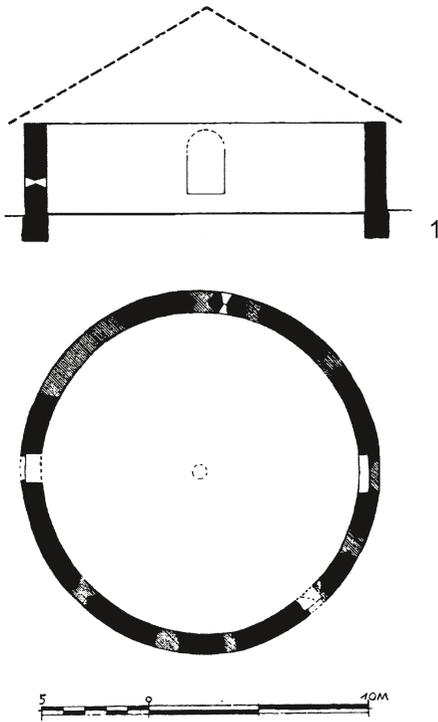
Hausbach, Stadt Vilshofen. 1 rekonstruierter Aufriss (nach Haas 1966, 141 Abb. 13); 2 Grundriss (nach Haas 1966, 142 Abb. 14).
